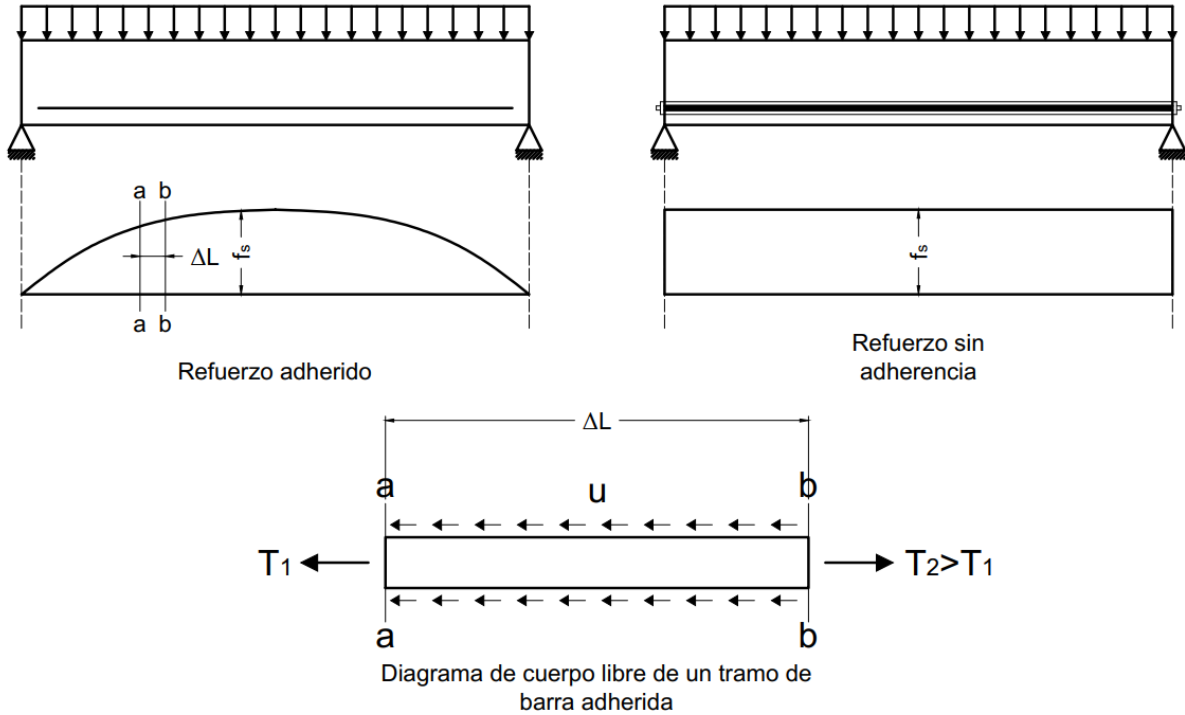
Comportamiento del refuerzo adherido y no adherido.
